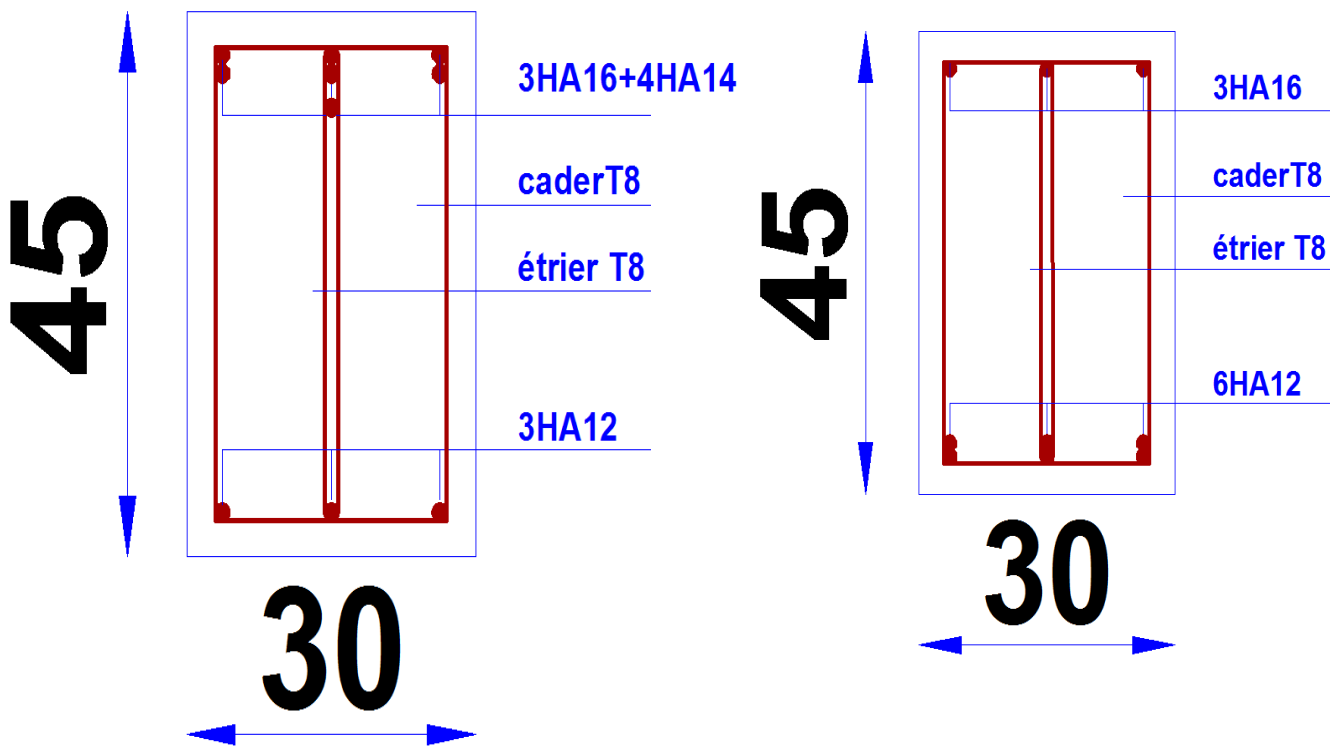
Schéma de ferrailage des poutres principales 30X45
